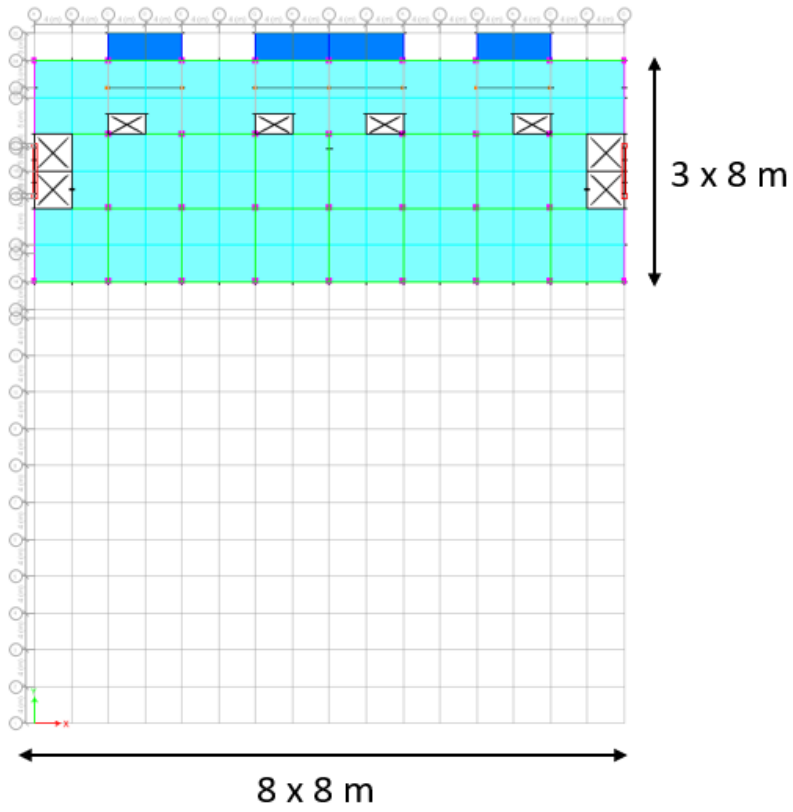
Denah Tipikal Lantai 7 dan 9 Untuk Model 3
